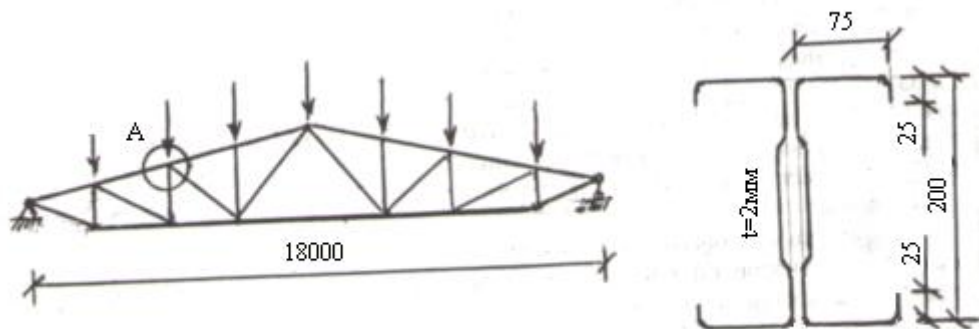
Схема ферм и сечение верхнего пояса.
